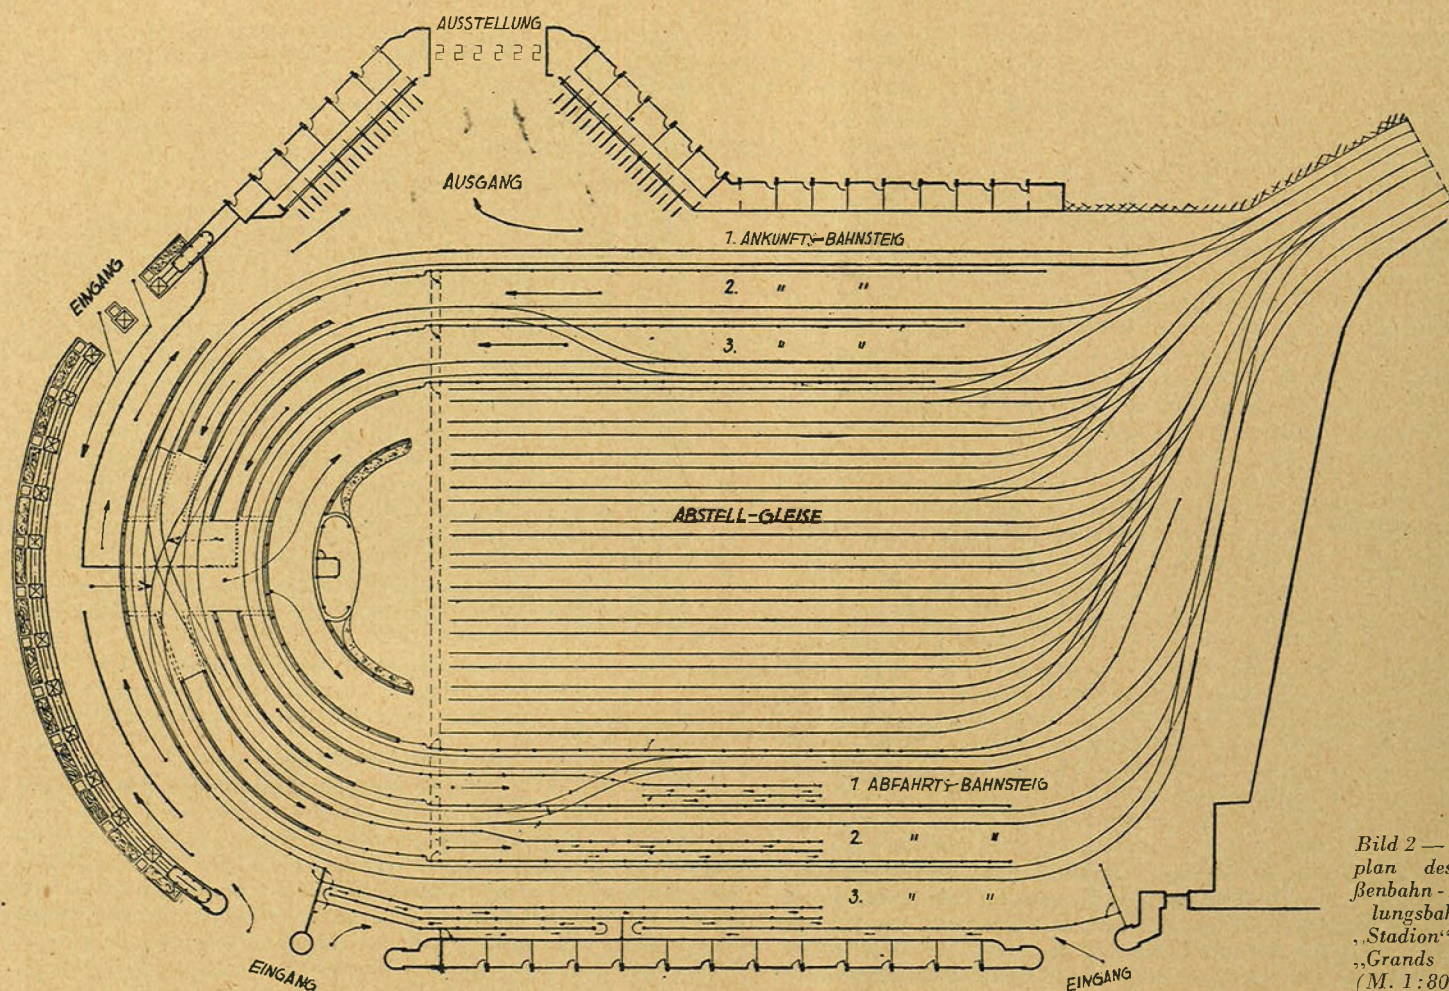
Gesamtplan des Straßenbahn-Ausstellungsbahnhofs „Stadion“ und „Grands Palais“ (M. 1:800)
